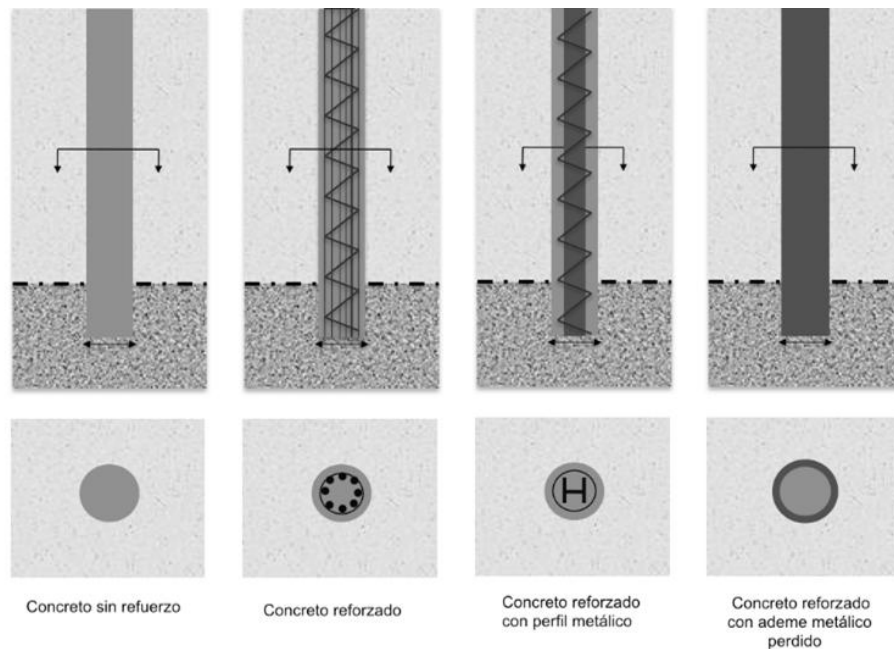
Tipos de refuerzo en pilotes y pilas de cimentación.
